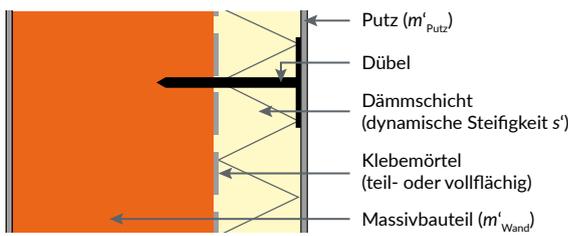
Aufbau einer Außenwand aus Ziegelmauerwerk mit WDVS
